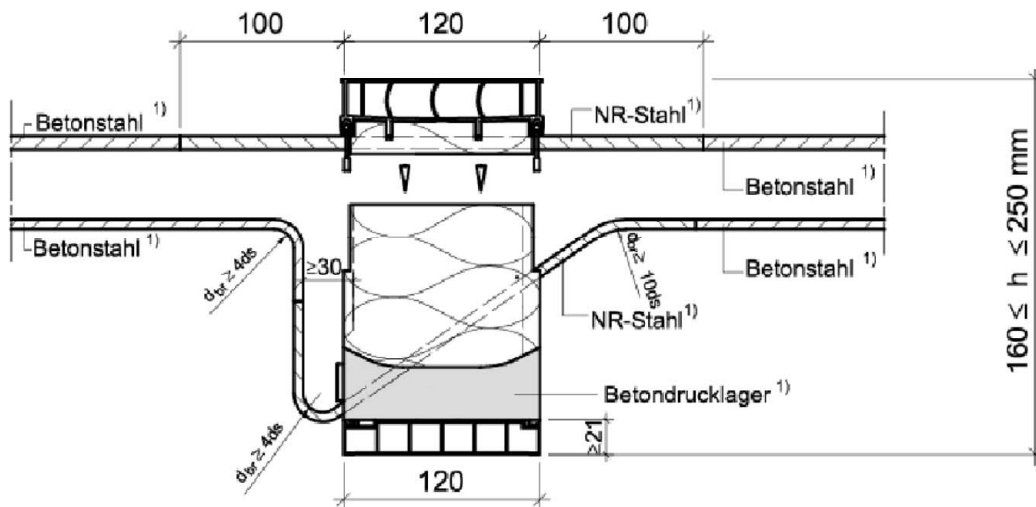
Schöck Isokorb® XT Typ K-ID mit Betondrucklager mit integrierter Aufhängebewehrung
